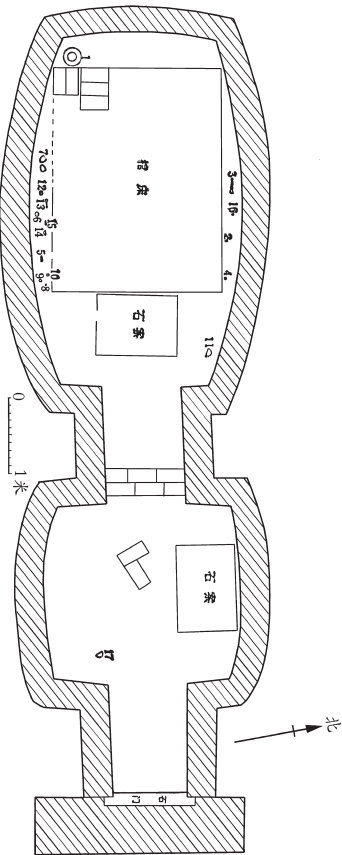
江苏省宜兴 4 号墓平面图 (1/100)
